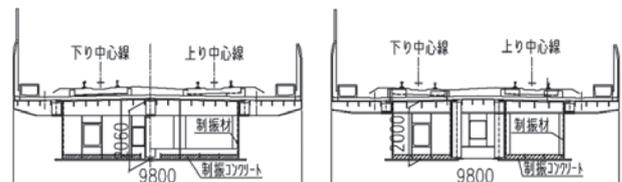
鋼桁の標準断面図 Gd1（左）とGd2（右）
